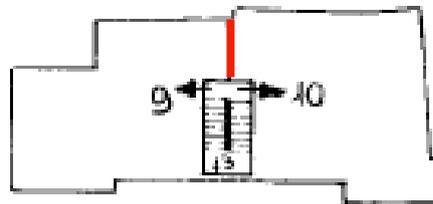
Stralcio elaborato planimetrico Comune di Paola, foglio 16, p.lla 330, sub.9 2° piano e sub.10 2° piano: evidenziata in rosso, la parete divisoria originaria
